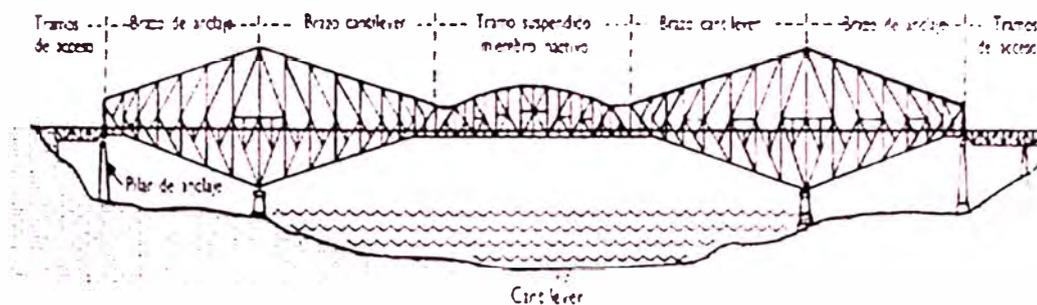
ESQUEMA DE PUENTE CANTILÉVER
